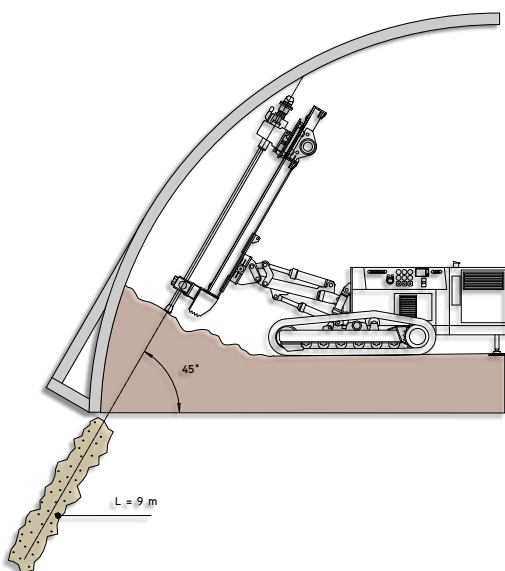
Sezione trasversale del tunnel mostrante l'intervento sulle centine.
